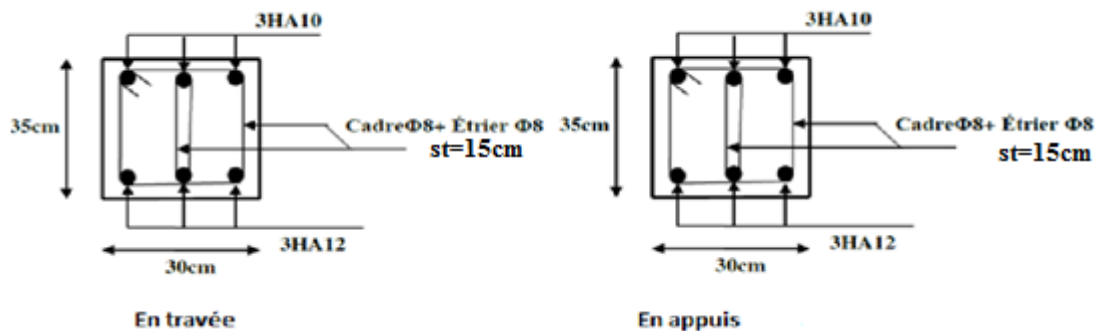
Schéma de ferrailage de la poutre de chaînage
